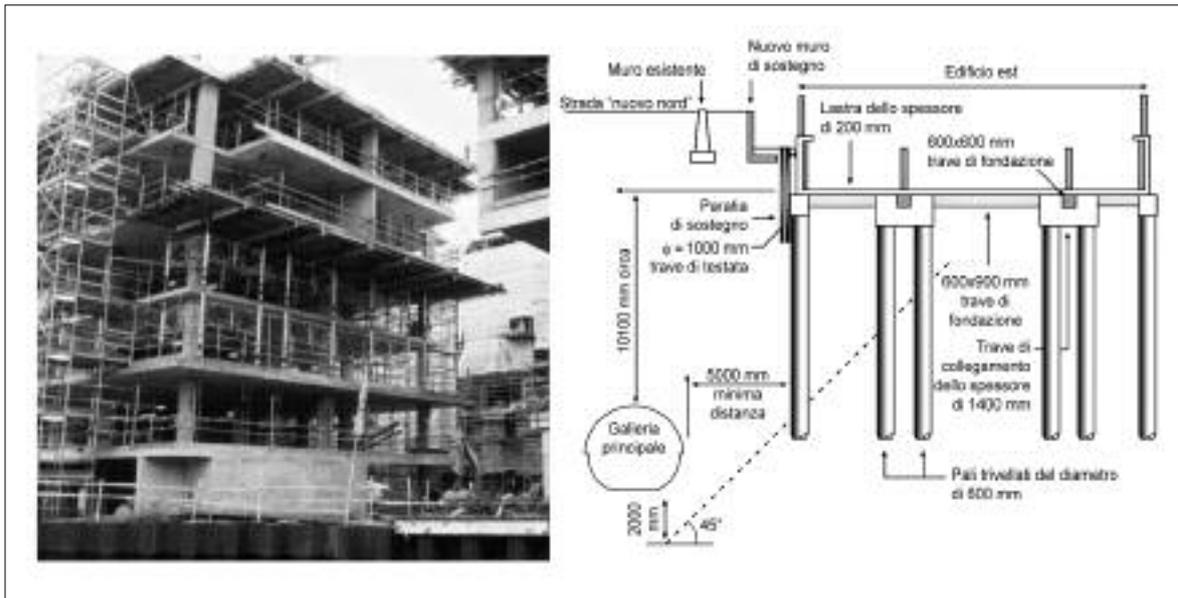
Sezione schematica relativa all'esecuzione delle fondazioni per la costruzione dei nuovi edifici ubicati nel centro di Londra
